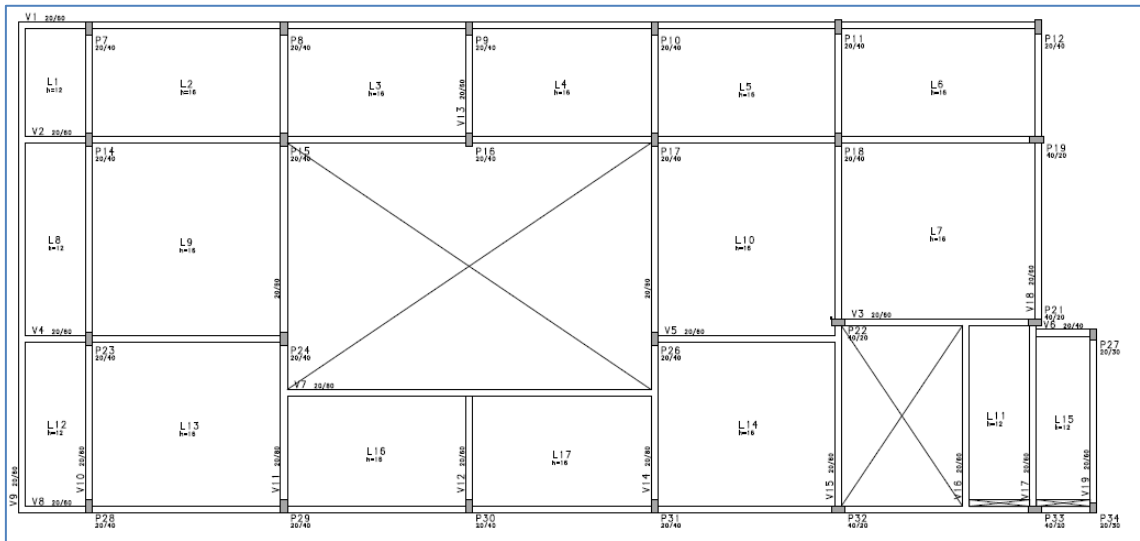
Planta de fôrma: 1º pavimento, concreto armado (CAD/TQS).
